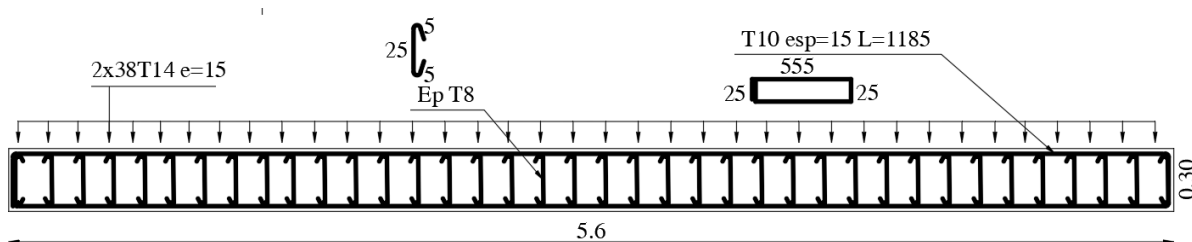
Schéma de ferrailage des voiles type 02.
